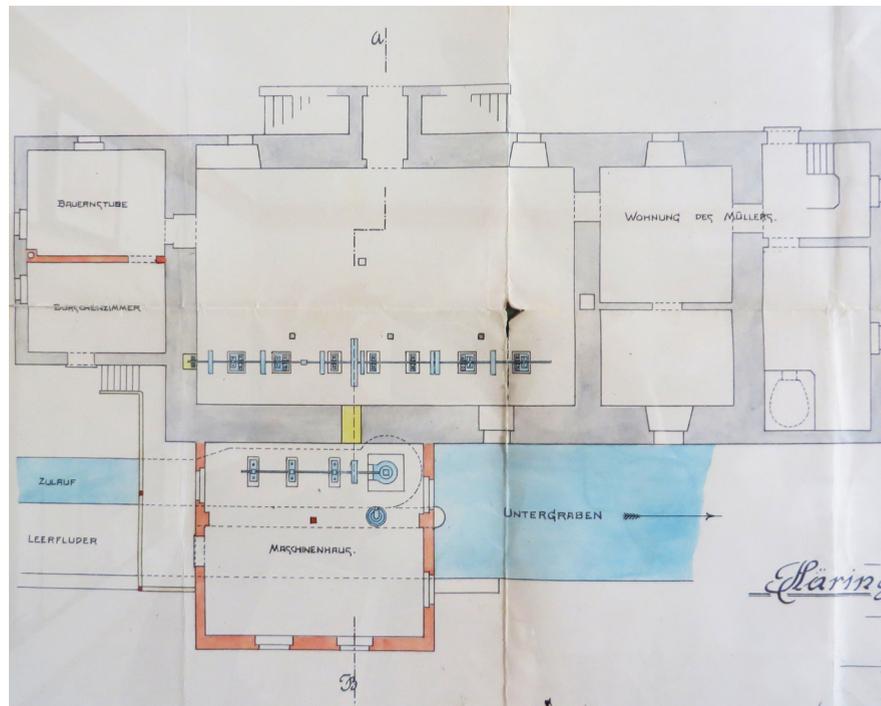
Plan aus 1916, Grundriss, Zubau des Triebwerksraumes
